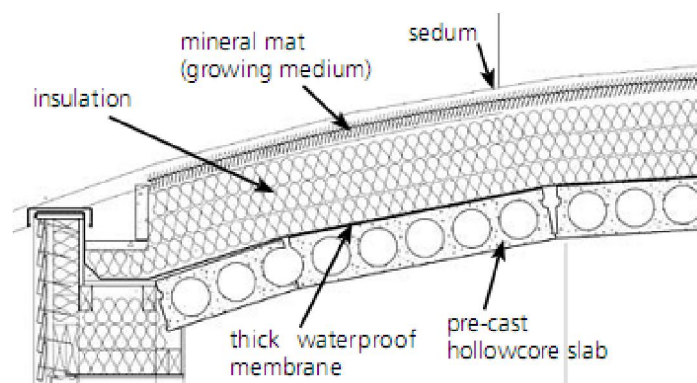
Pormenor construtivo da laje de cobertura do edifício BedZED [41]
